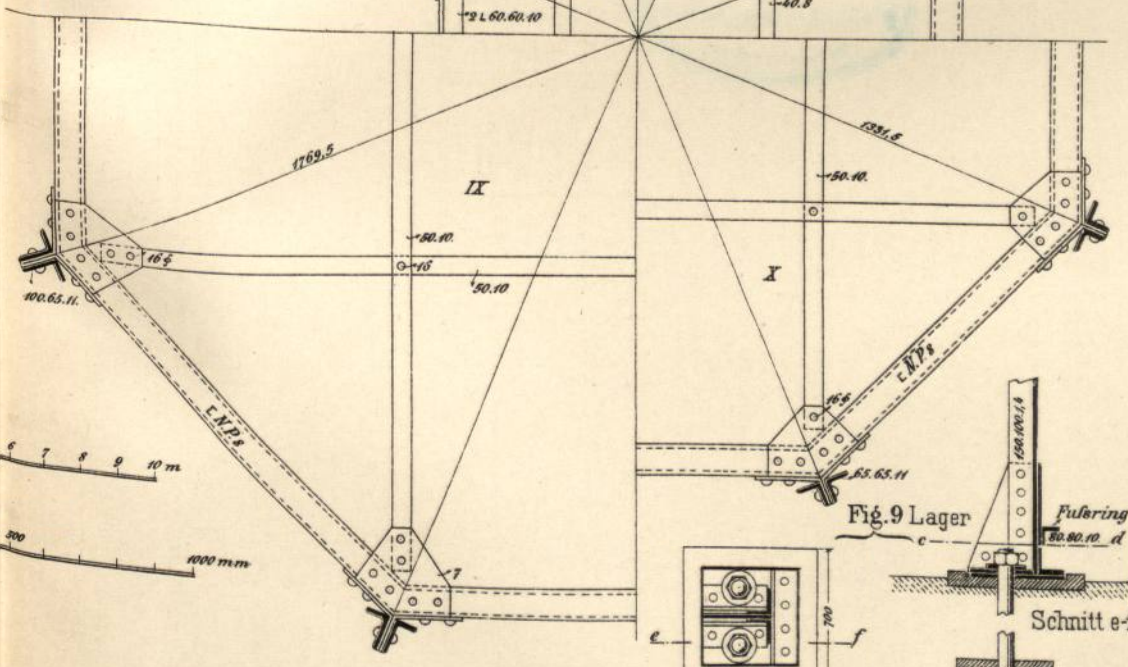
Grundrisse der Ringe IX-XII
